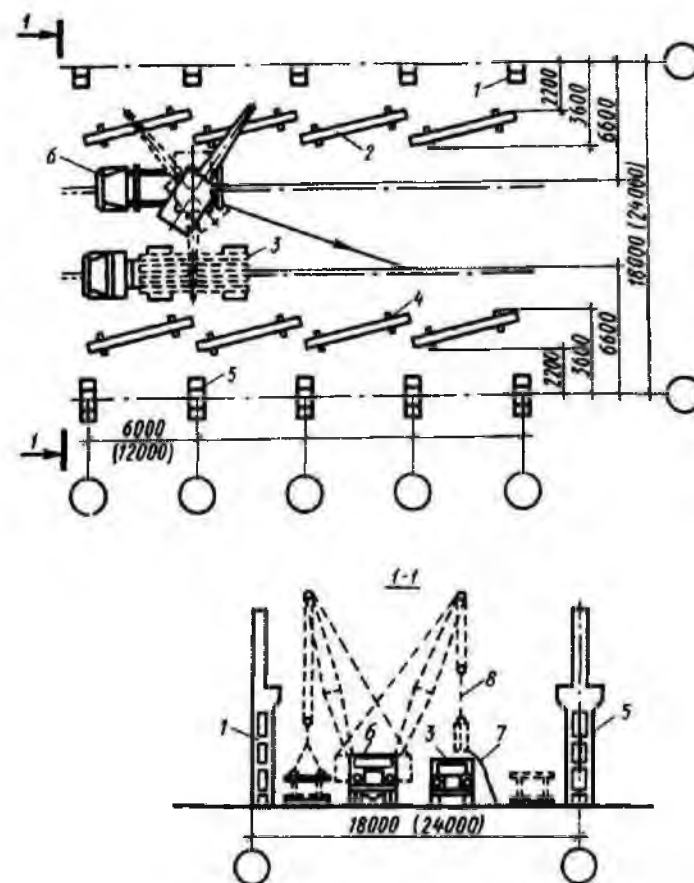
Схема выгрузки и раскладки подкрановых балок пролетом 6 и 12 м:
